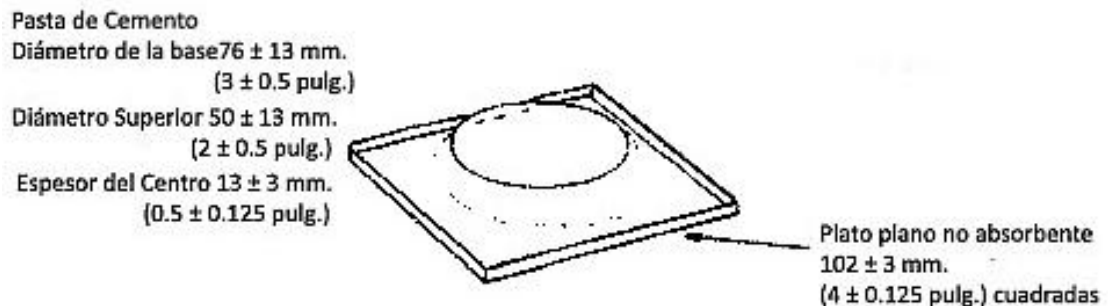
Dimensiones y Tolerancias del Moldeado de la Pasta de Cemento.
